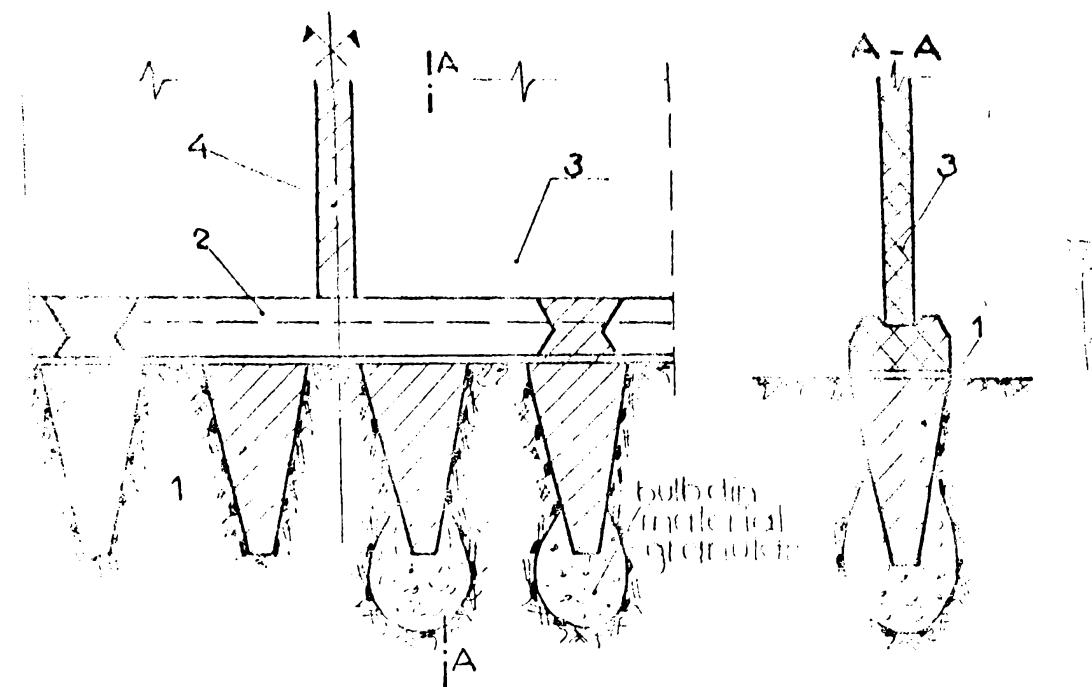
Fundații continue sub pereti utilizând pe colțari: 1) coltar din beton simplu (cu sau fără bulb); 2) talpă prefabricată sau monolitică; 3) elevație prefabricată; 4) monolitizarea elevațiilor prefabbr.
